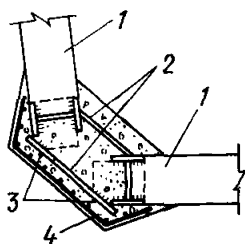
Сопряжение сборных вертикальных стенок бункеров с железобетонной колонной
